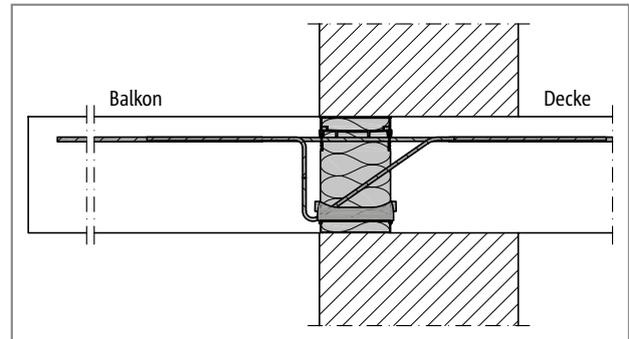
Schöck Isokorb® Typ KXT: Anschluss bei einschaligem Mauerwerk
